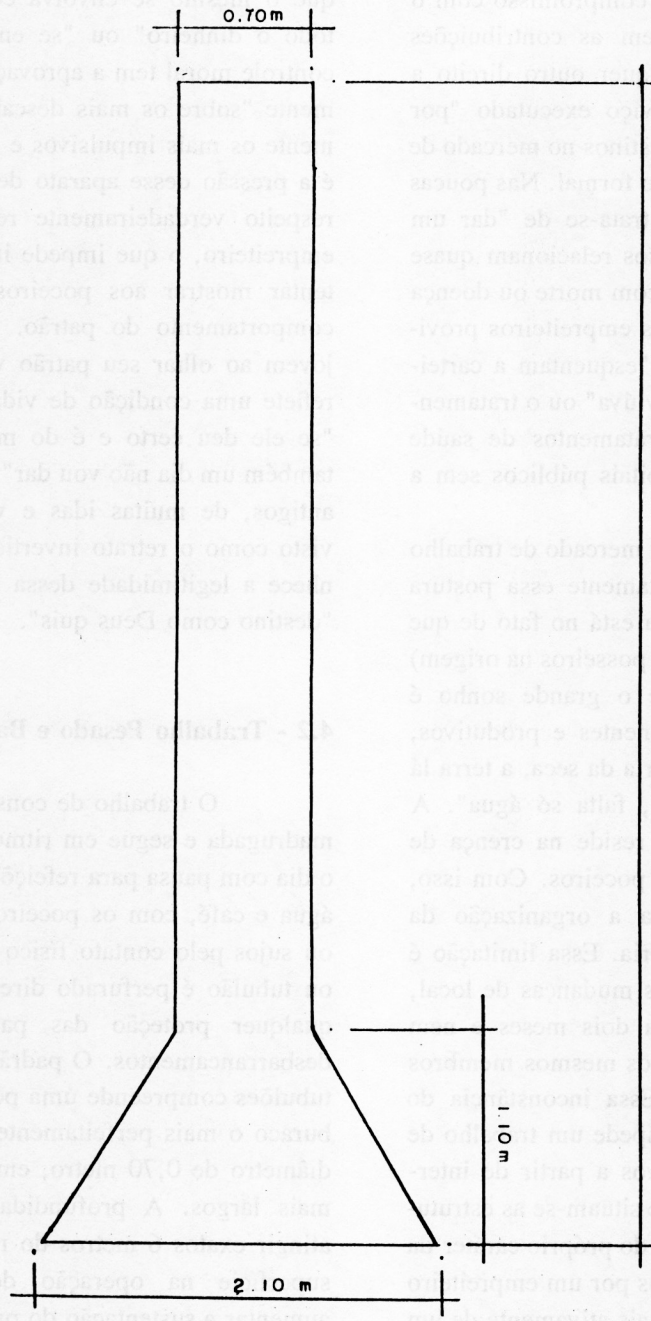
Corte Vertical da Estrutura de um Poço Típico da Construção Civil Paulistana.
